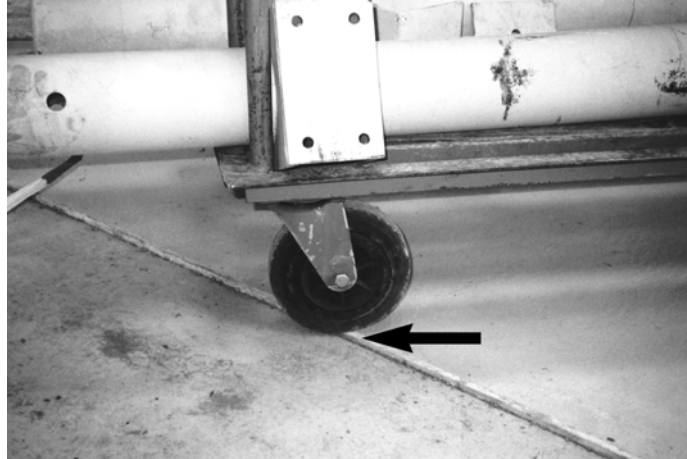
Schadensträchtiges Befahren einer mit Dämmstreifen ausgebildeten Baukörperfuge [10]
